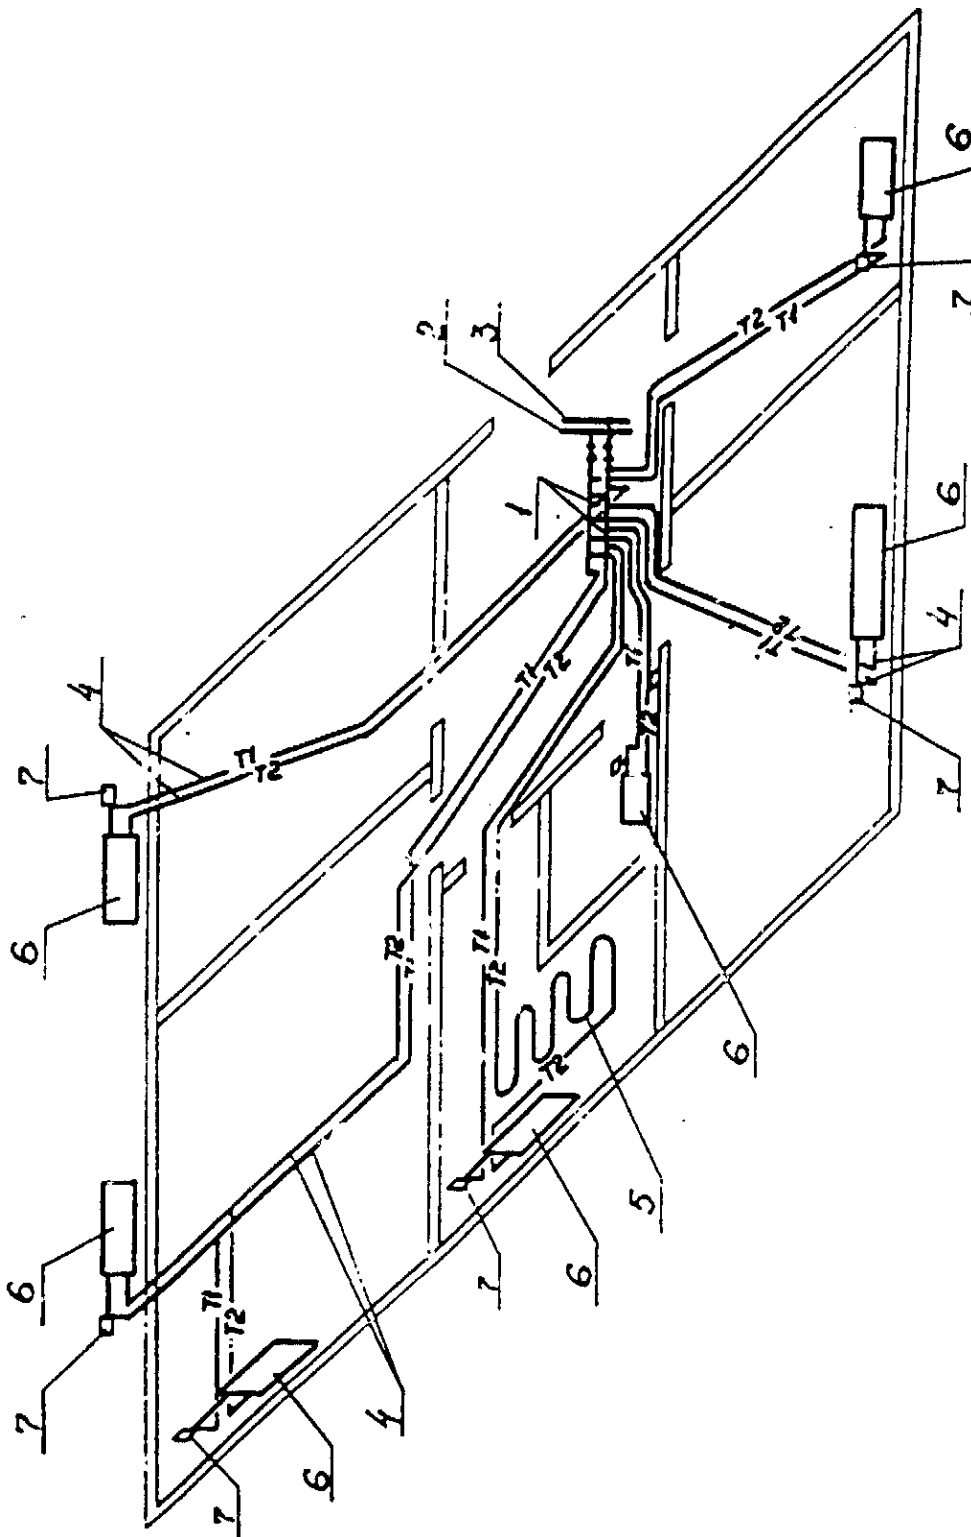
Лучевая схема напольной разводки теплопроводов от вертикальных стояков у внутренних стен. 1 – гребенка, 2 – подающий стояк, 3 – обратный стояк, 4 – подводящие теплопроводы, 5 – теплопроводы напольного отопления, 6 – радиаторы, 7 – термостаты.
